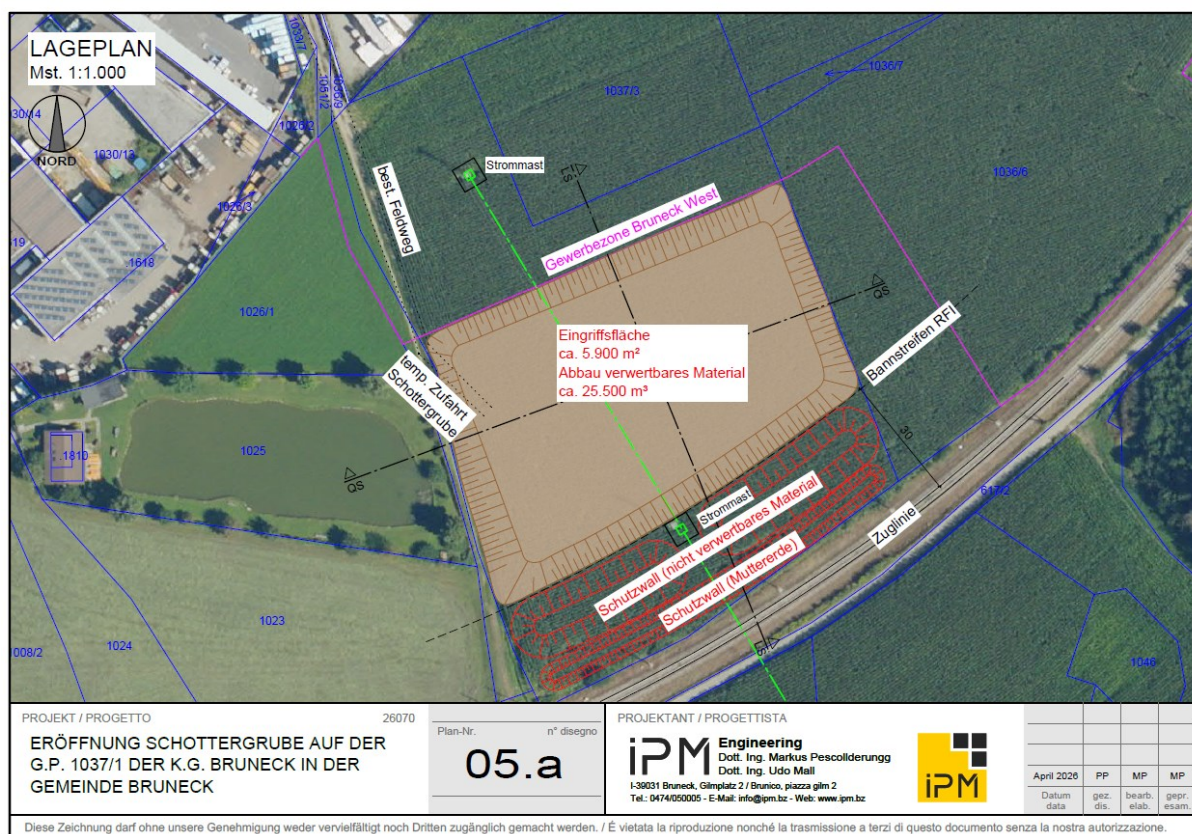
Ausschnitt „Lageplan Projekt“ von Projektunterlagen des Ingenieurbüros IPM
